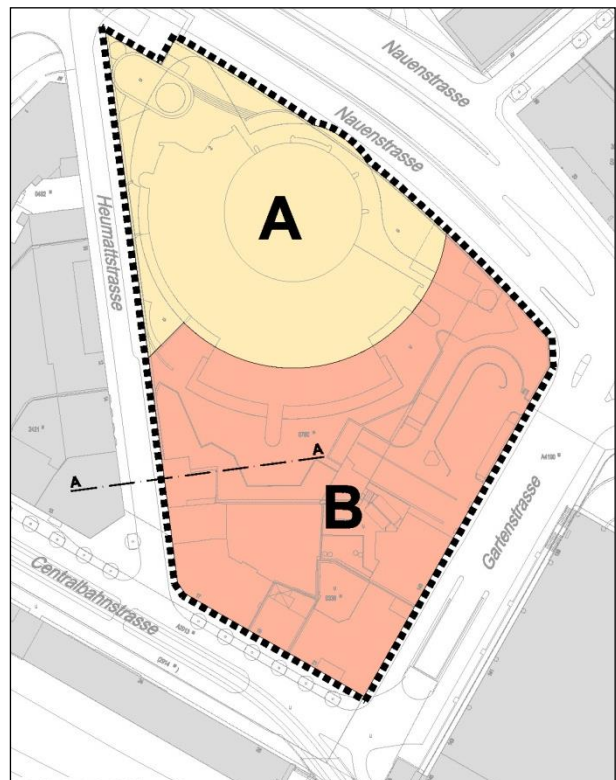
Neuer Bebauungsplan, Situation. Plan Nr. 13'810 (Plan genordet, ohne Massstab)
